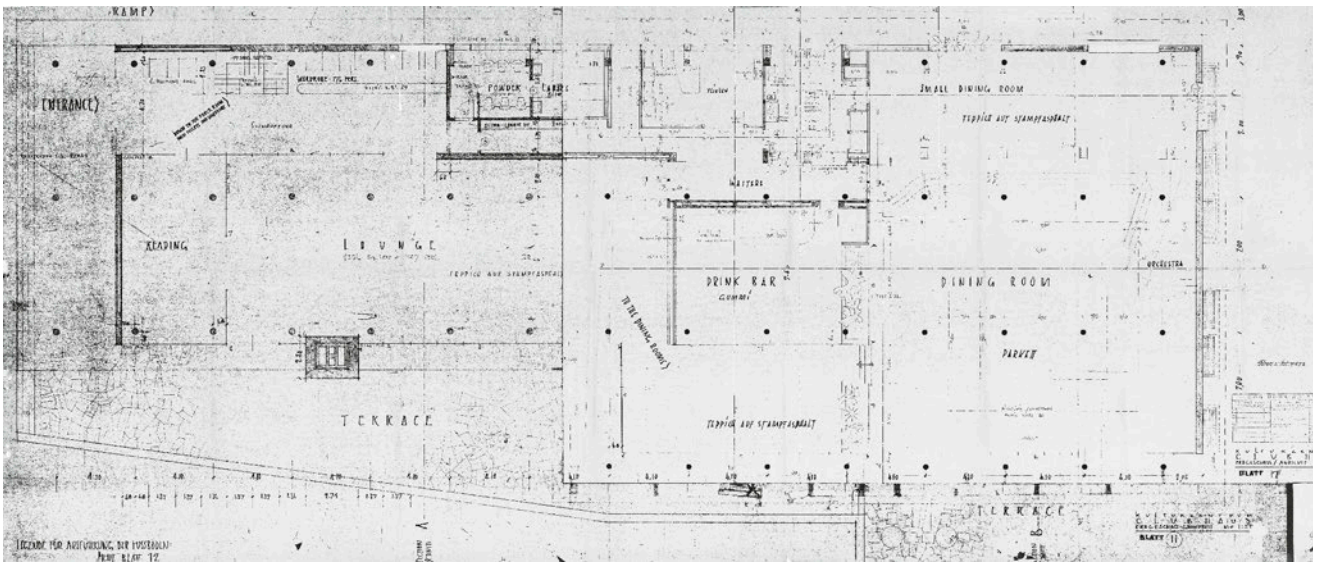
Clubhaus, Grundriss Hauptgeschoss v. 7. März 1952. Bauordnungsamt der Stadt Bonn, Bauakte 4563
